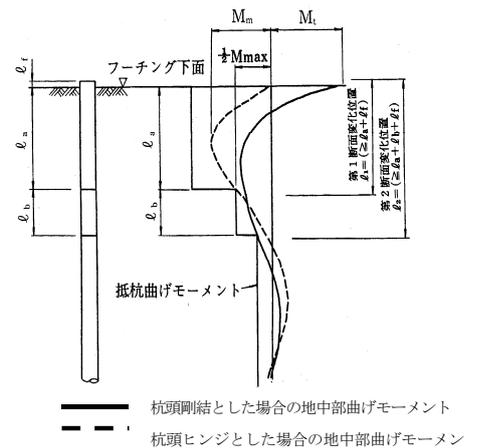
鋼管杭の断面変化の設計位置（杭基礎設計便覧, 図-III. 2. 49, H27. 3, 日本道路協会）
